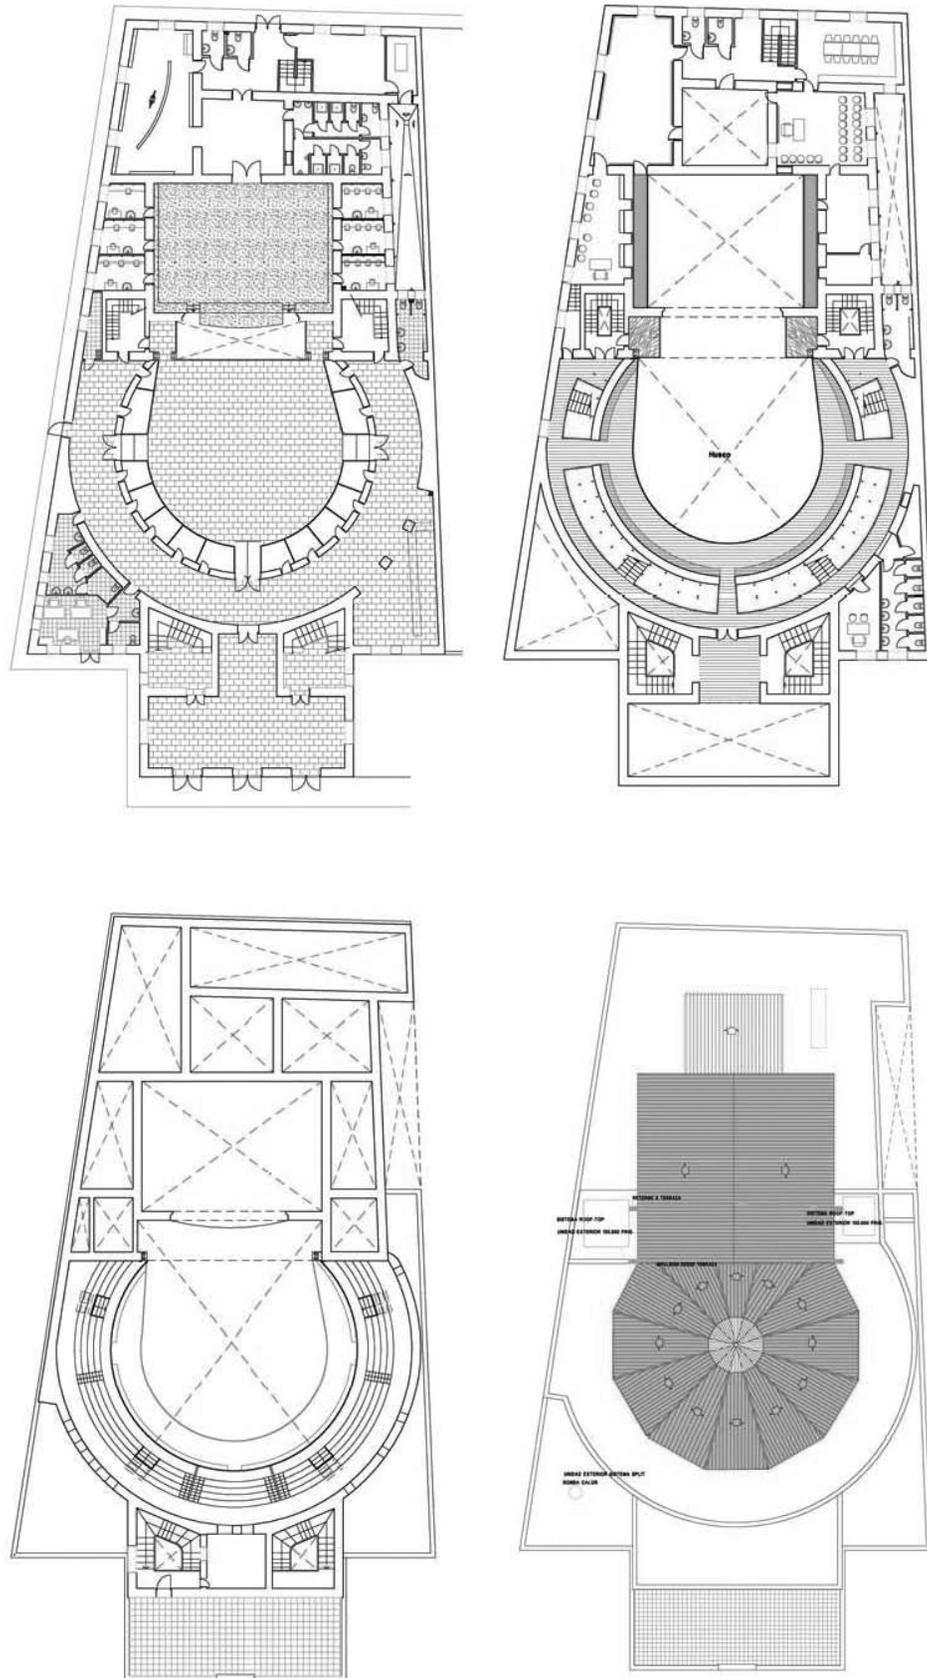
Planos de plantas del Proyecto de restauración y acondicionamiento del Teatro Apolo, año 2006.
